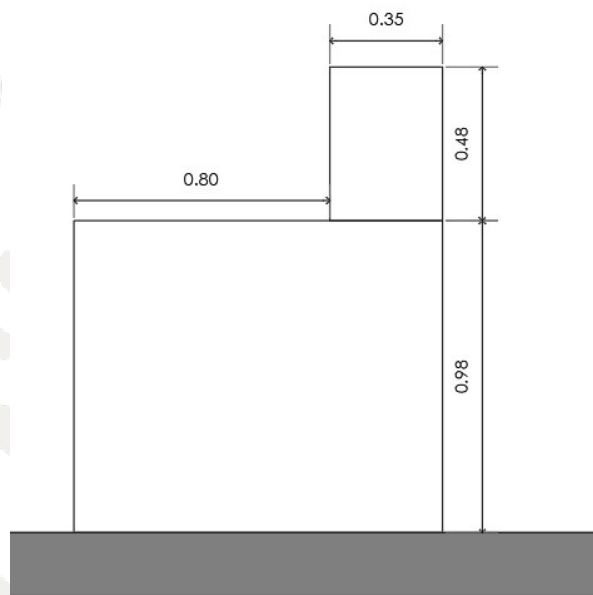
Planta arquitectónica modulo experimental, Fuente: Propia.
